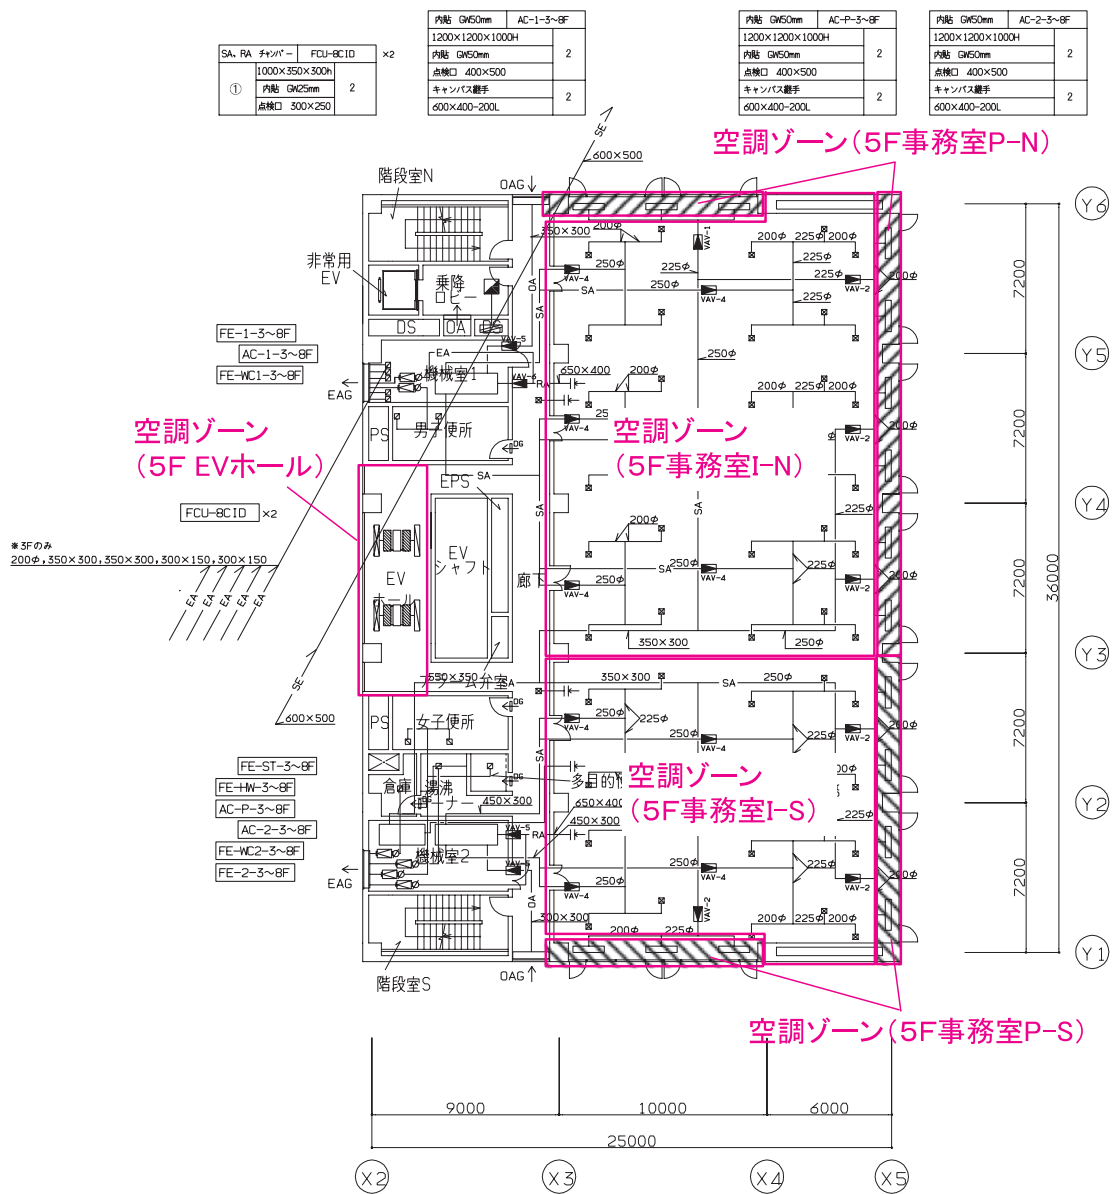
\* 空調設備 3～8階ダクト平面図 (図面-空-13)
